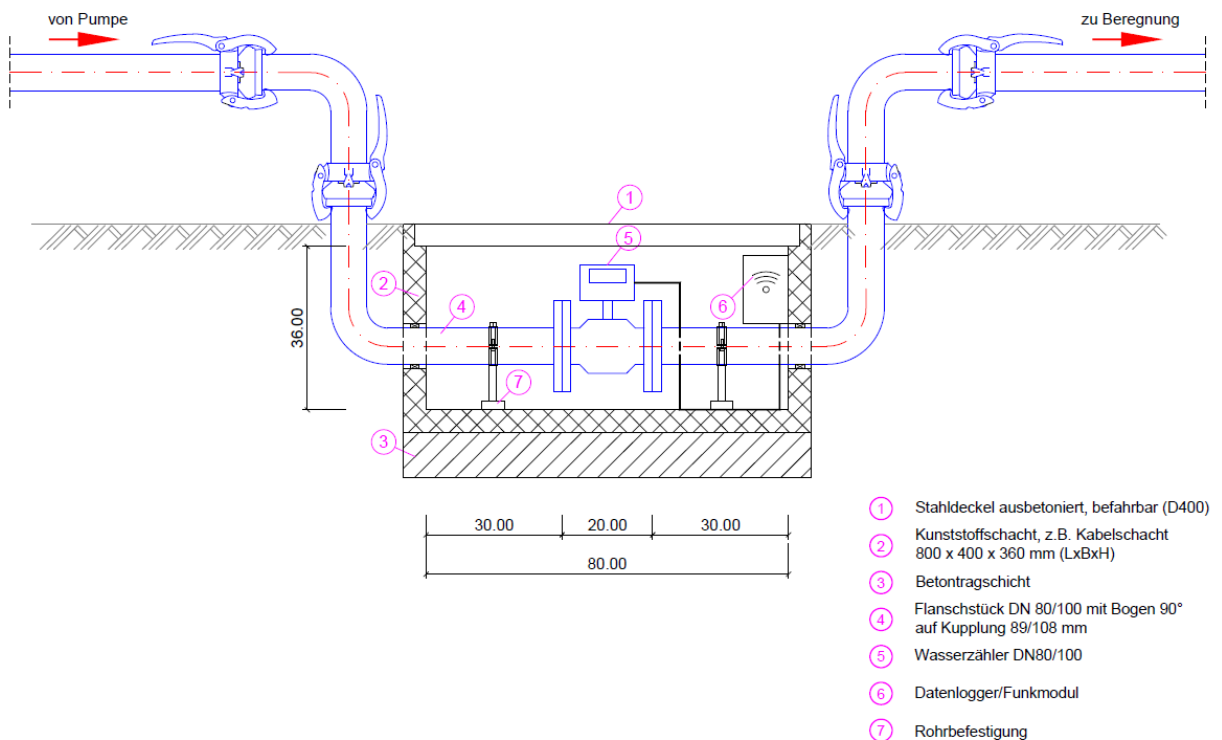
Messschacht mit fest installiertem Durchflussmessgerät (Betrieb bei geschlossenem Deckel)
